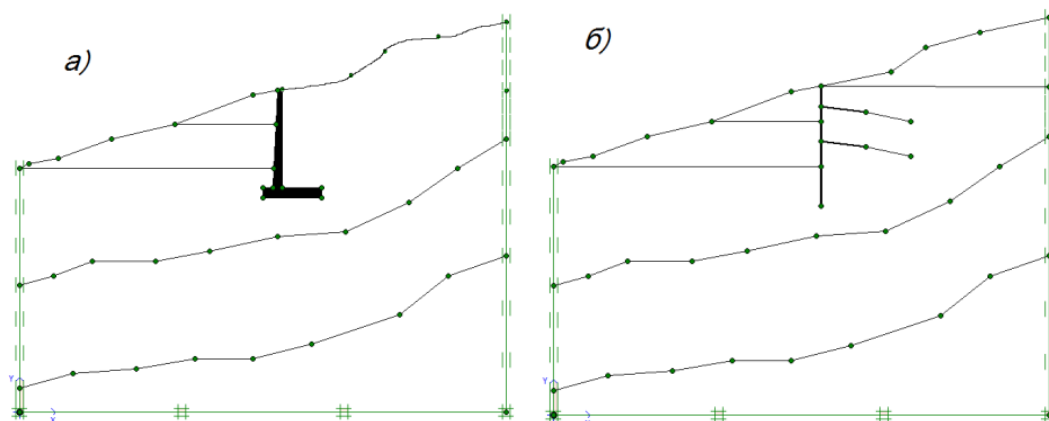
Расчетные схемы подпорных стенок реализованные в программе Plaxis: а – угловая консольная; б – шпунтовая заанкеренная.
